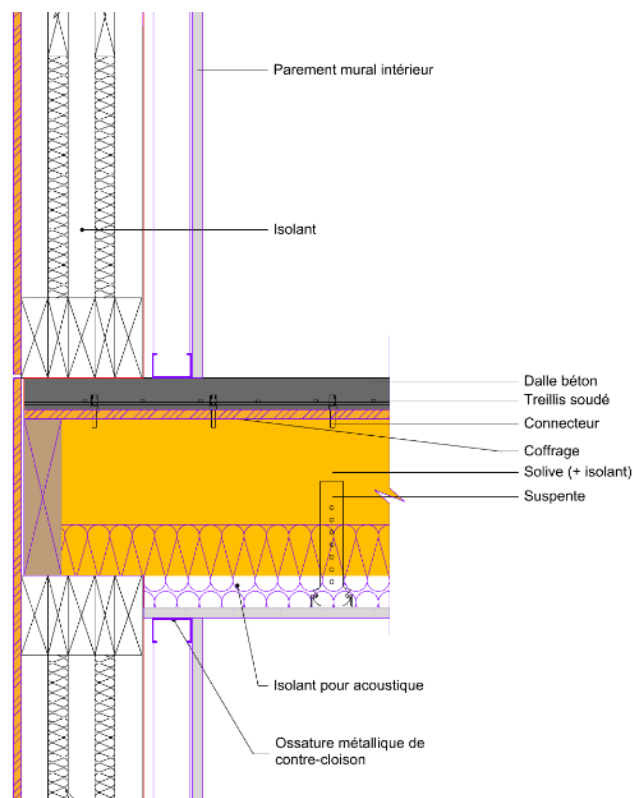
Exemple de Connexion entre mur LEKO LABS et plancher mixte bois béton (sous Avis Technique)
